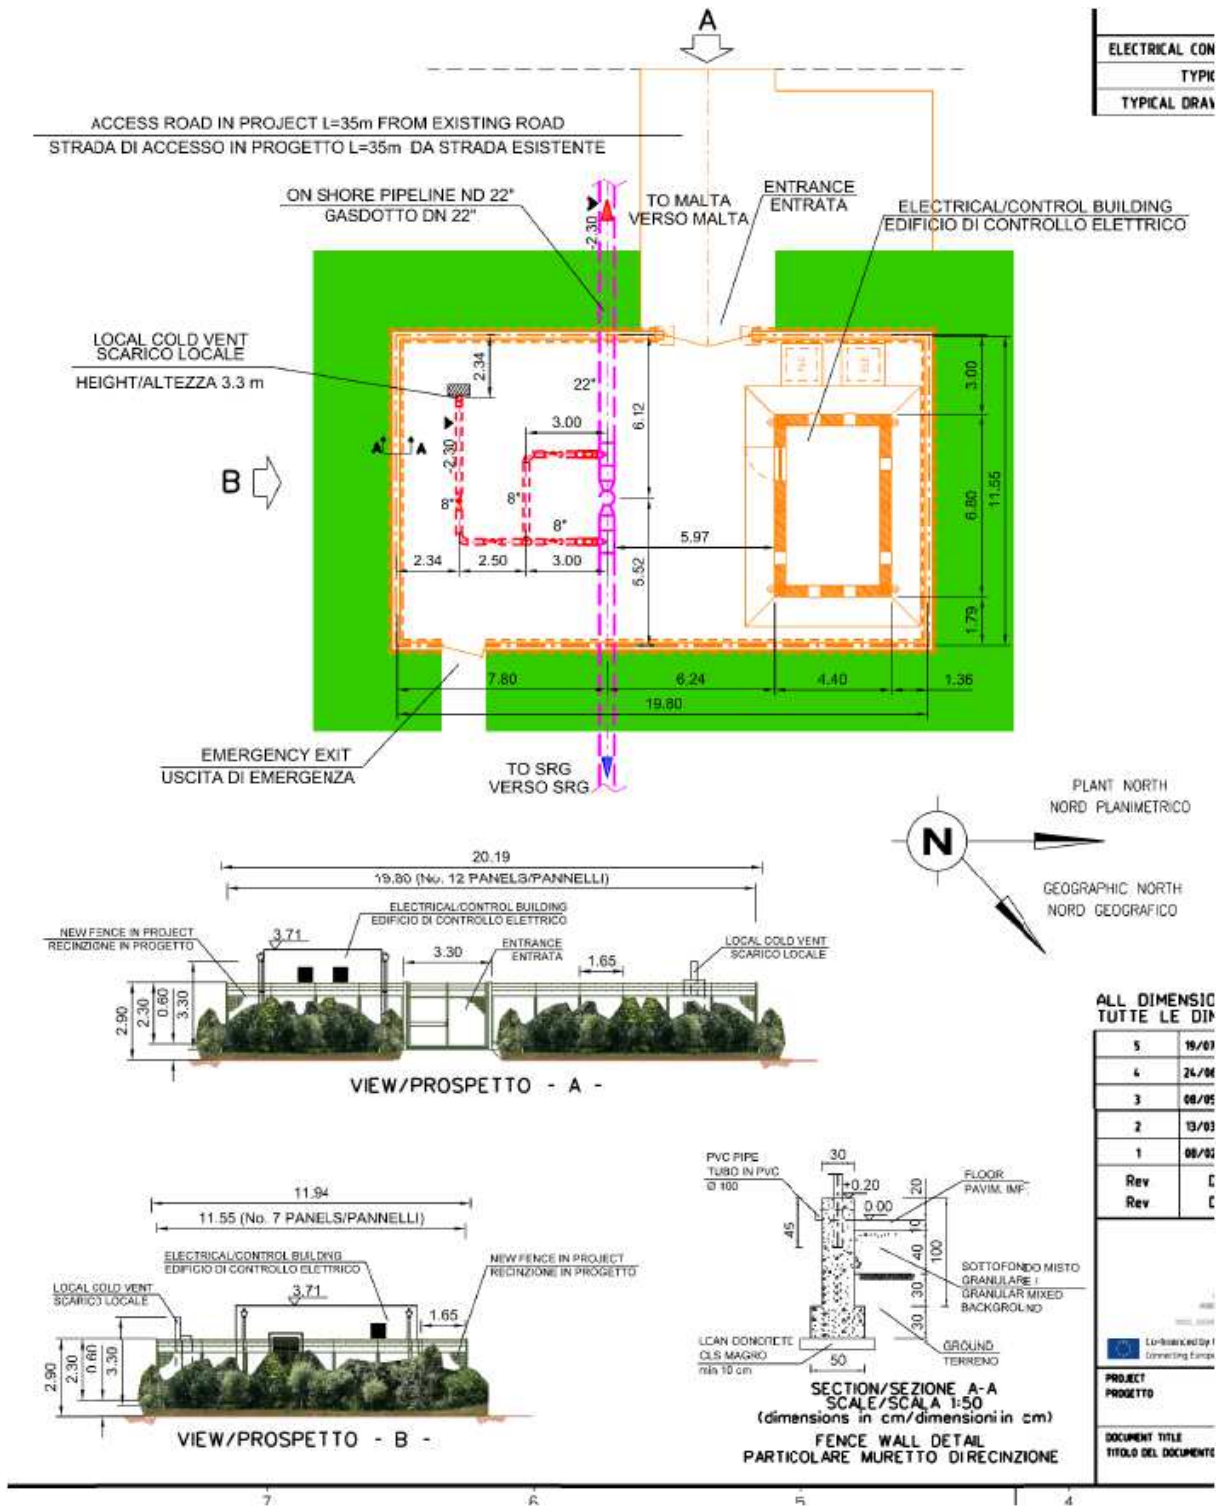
Punto di intercettazione di linea 3 – Planimetria e prospetti
